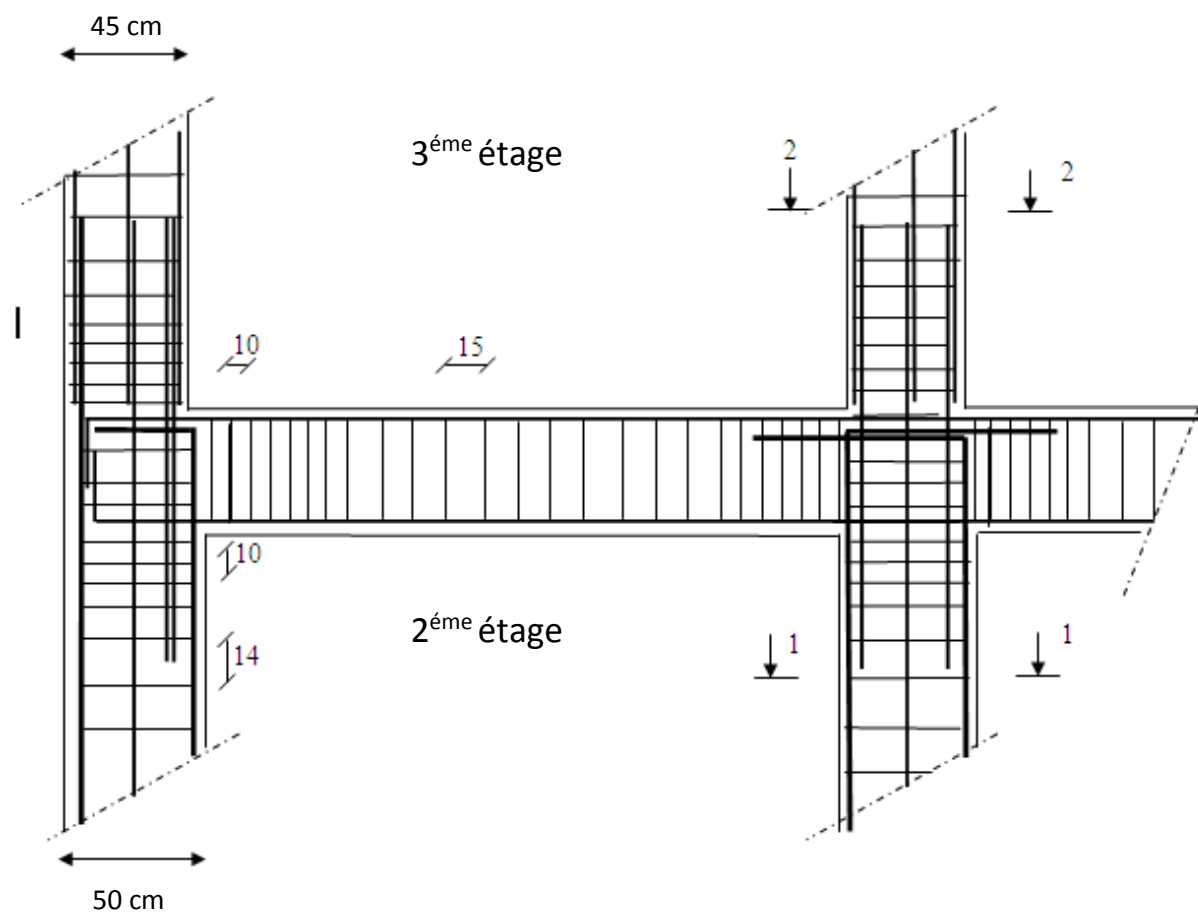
Plans de ferrailage des poteaux (cas de changement de section)
